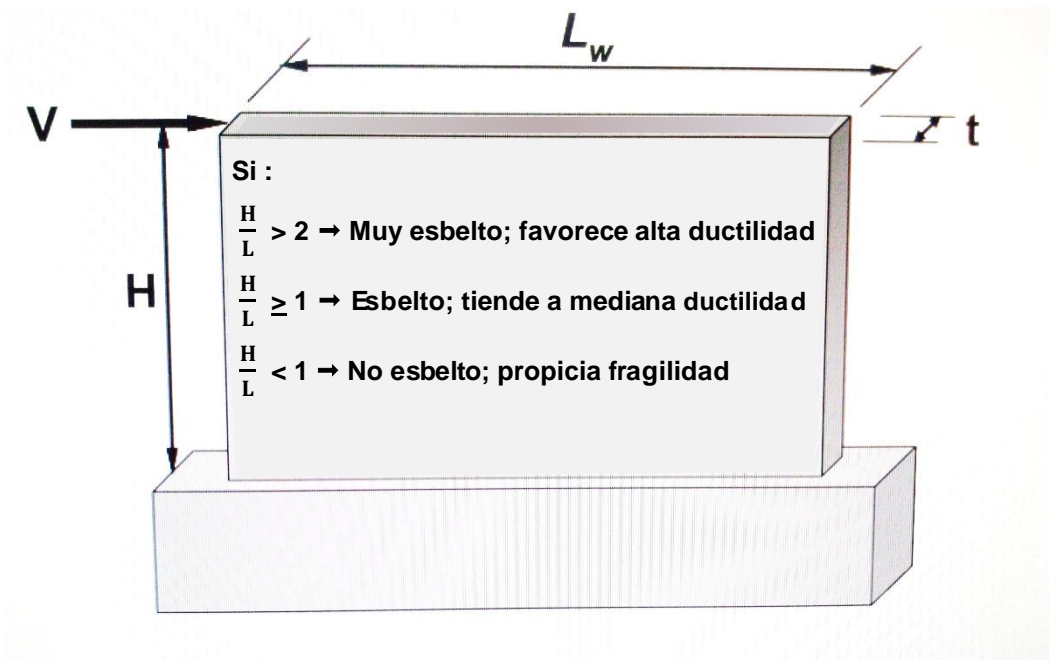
e.1-1) Esquemas de: forma básica, y tipos de muros estructurales de acuerdo a su configuración en planta y elevación
